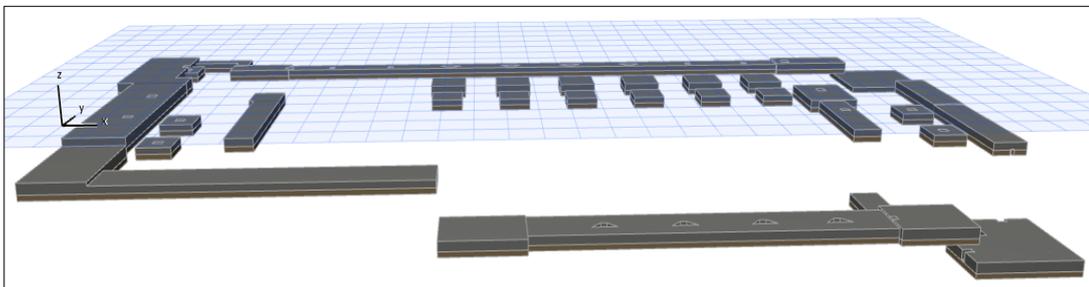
Alzado de planta de cimentación en 3D de maqueta final
